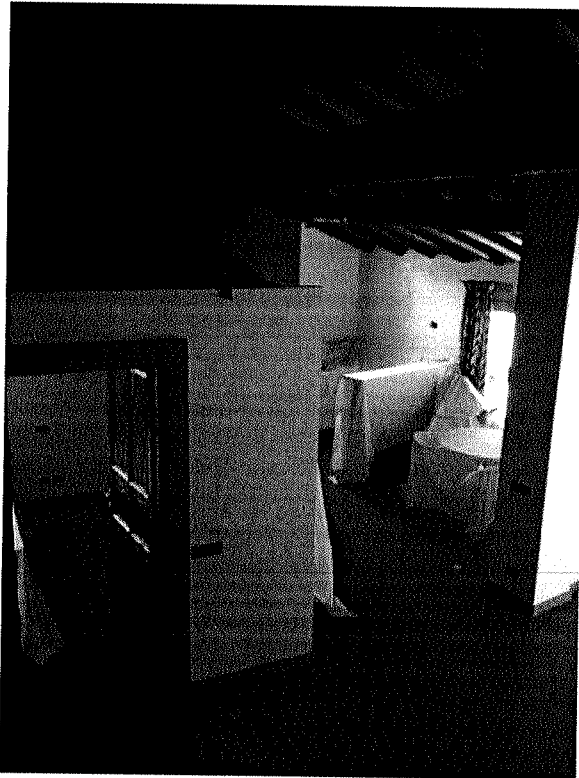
Vista interna da soffitta verso angolo cottura
